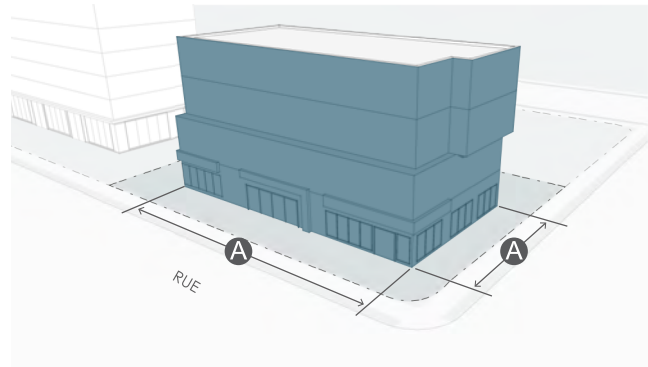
Mesure de la largeur d'une façade lorsqu'au moins un établissement d'un bâtiment est uniquement accessible par un couloir, un corridor ou un escalier intérieur
